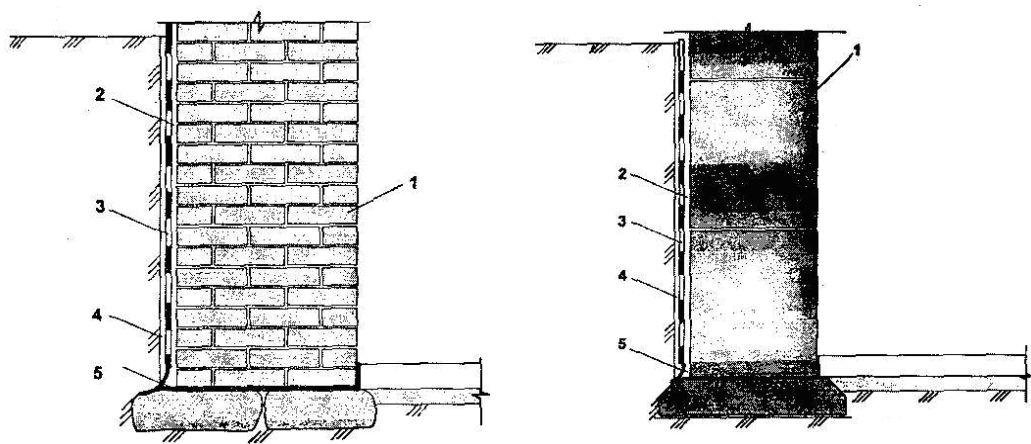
Захист підземної частини будівлі влаштуванням вертикальної гідроізоляції: 1 – існуюча стіна будинку; 2 – цементно-піщана штукатурка; 3 – вертикальна гідроізоляція; 4 – захист гідроізоляції; 5 – падуга (бетон або піщано-цементний розчин)
